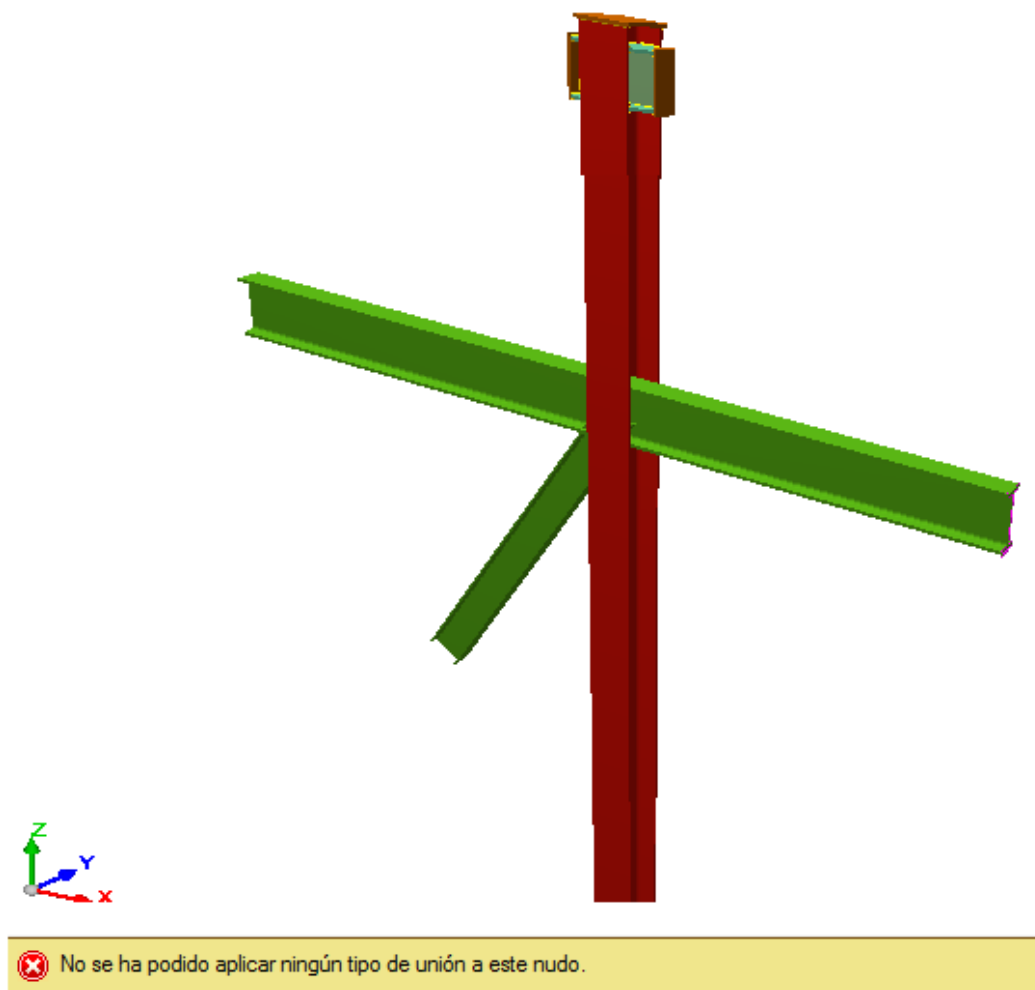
Detalle en soldadura no calculada
